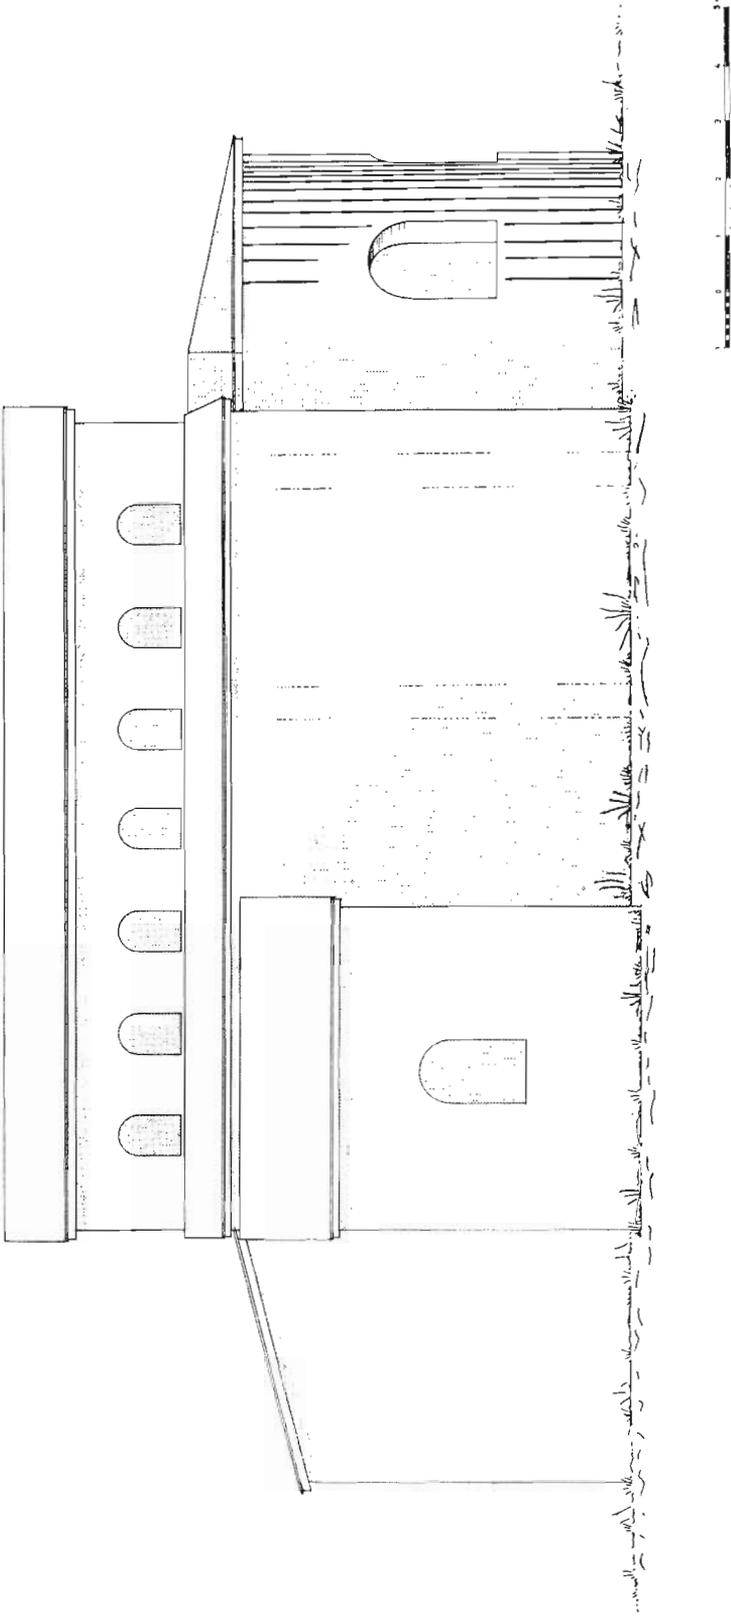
San Pedro en Veranes: alzado exterior Sur del baptisterio y basilica (reconstrucción, según Manzanares)
